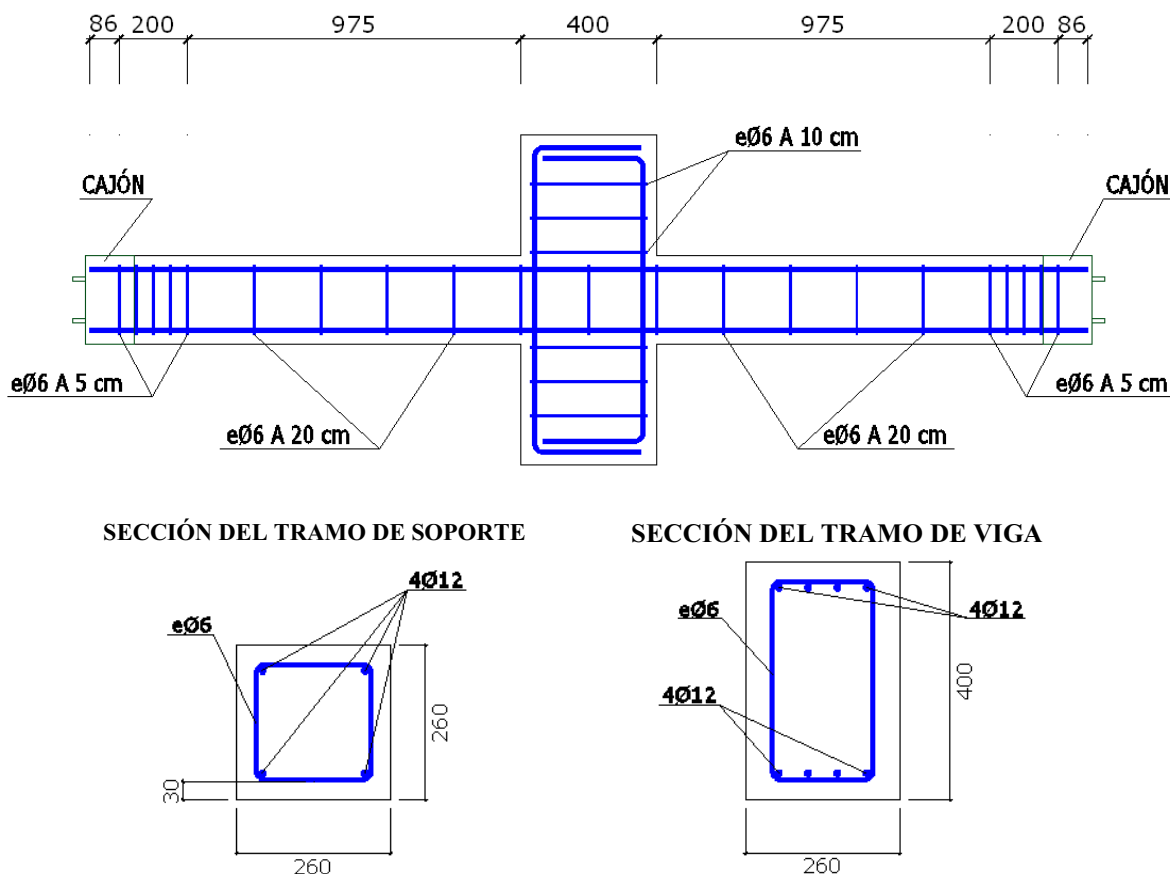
Armado de las probetas ensayadas (cotas en mm)
